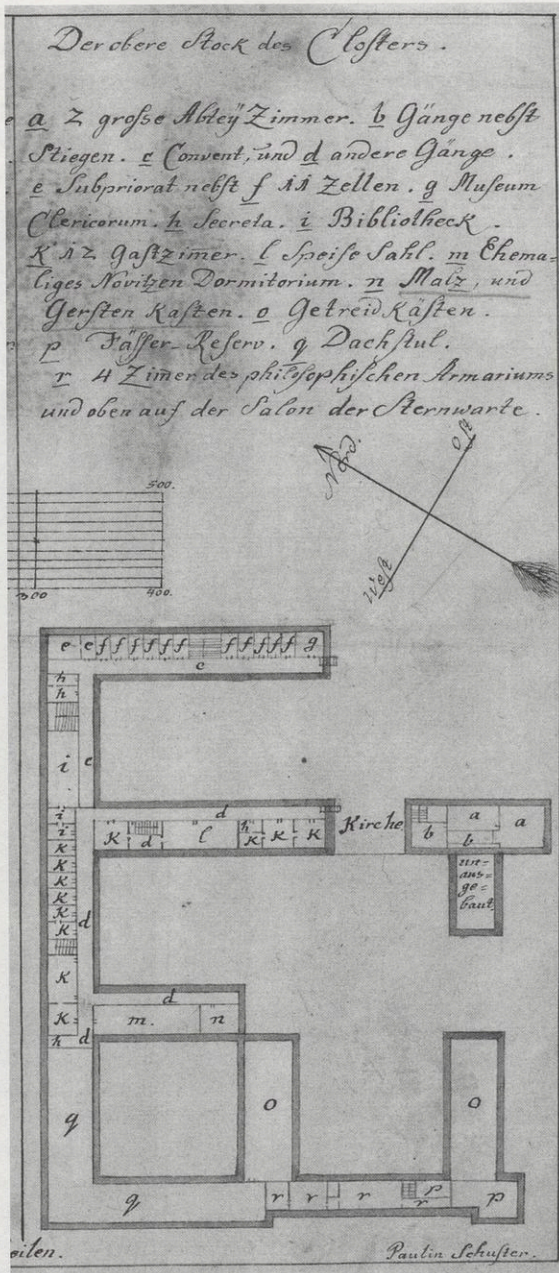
Das obere Stockwerk in Schusters Plan; am unteren Ende sind die vier Räume des Armariums mit dem Buchstaben „r“ gekennzeichnet.
